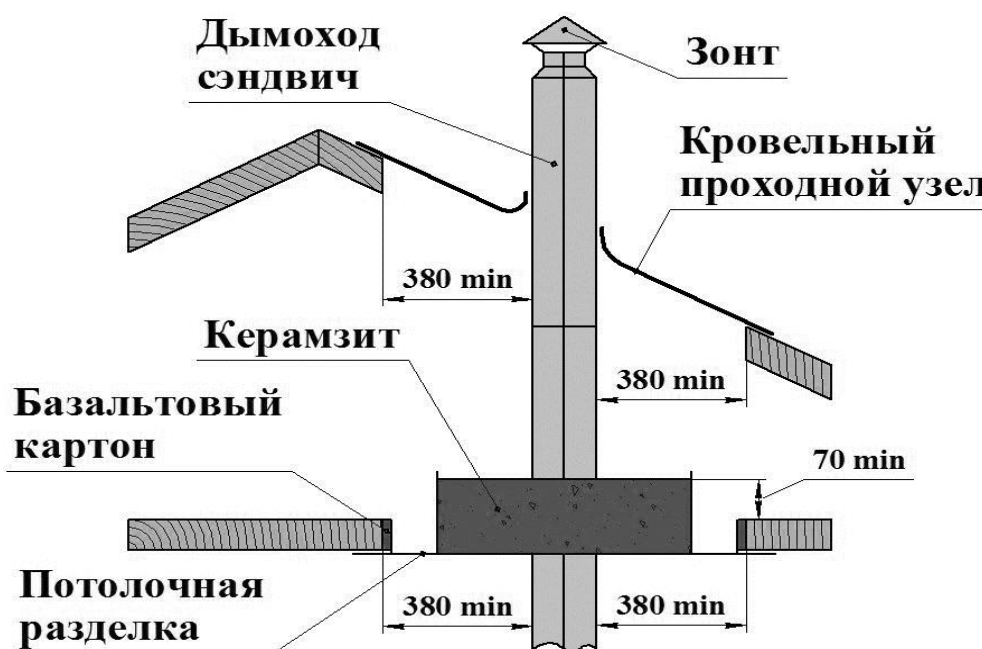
Требования безопасности при прохождении дымовой трубы через межэтажные перекрытия и кровлю
